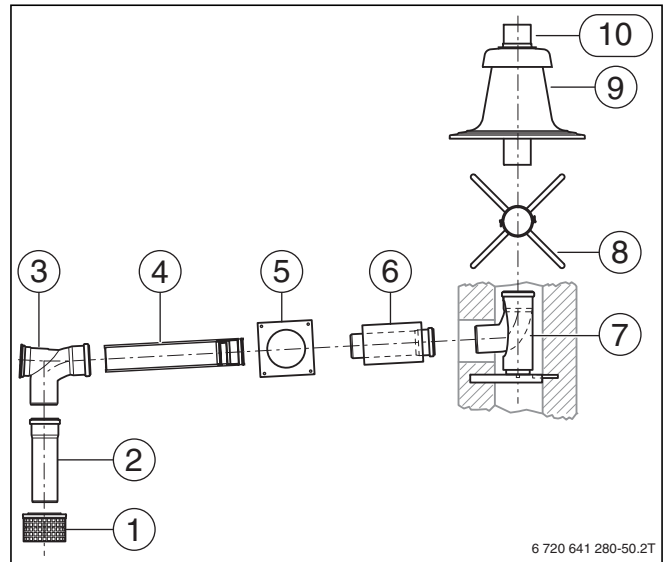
Bauteile des Grundbausatzes GA aus Kunststoff
